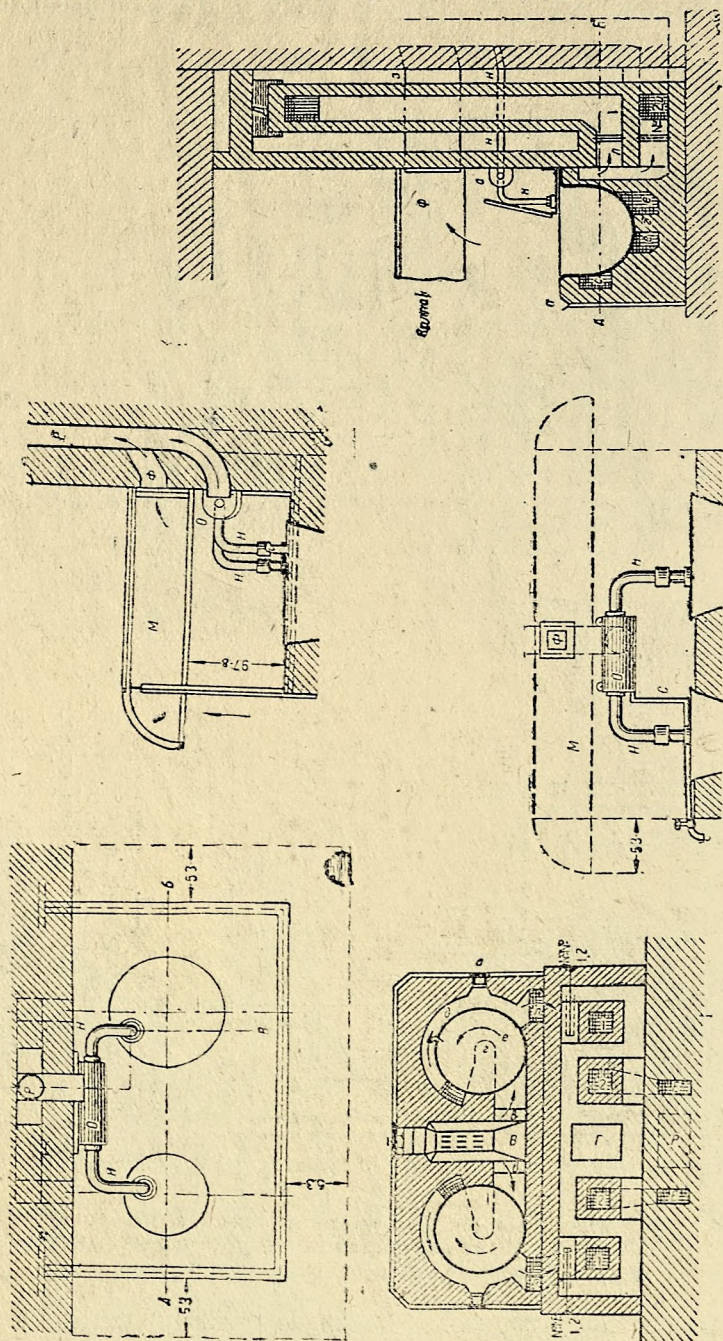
Прачечный отаг на два котла с вентиляционным каналом и подогревом наружного воздуха.
